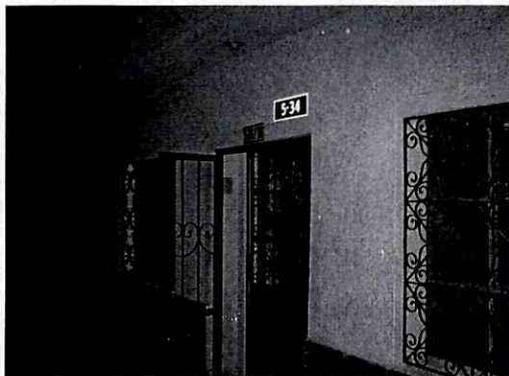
Se la fachada de la vivienda emplazada en la Calle 29 Bis No. 5-34.
